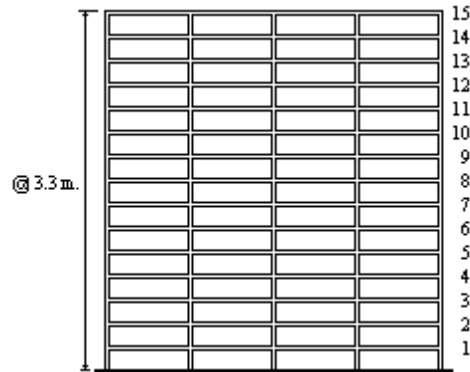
Elevación para el edificio de 15 niveles
